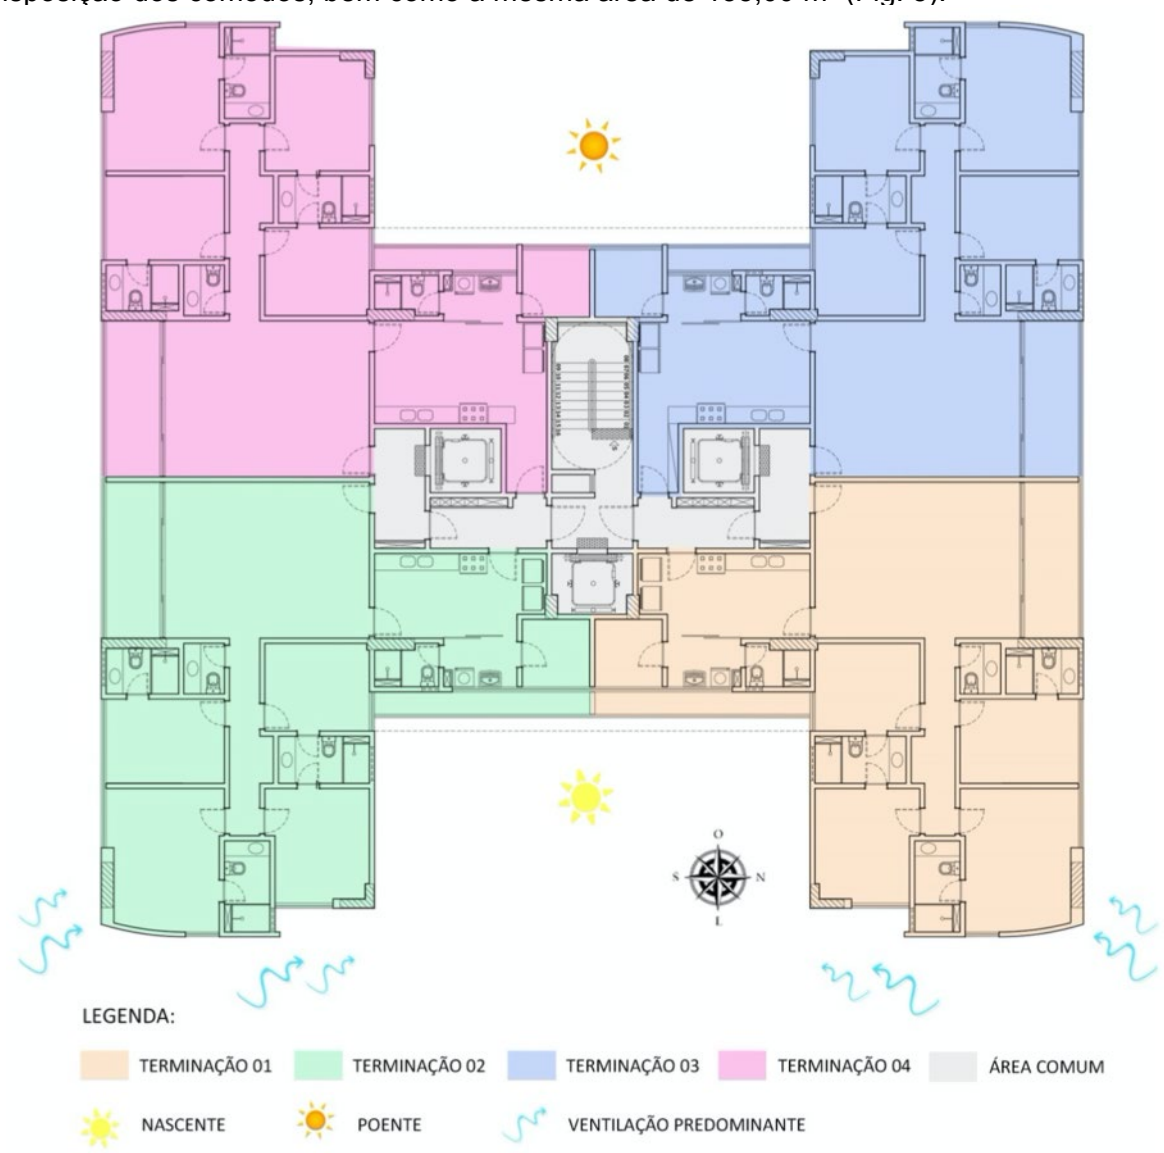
Planta baixa do pavimento tipo do edifício Wave Park
